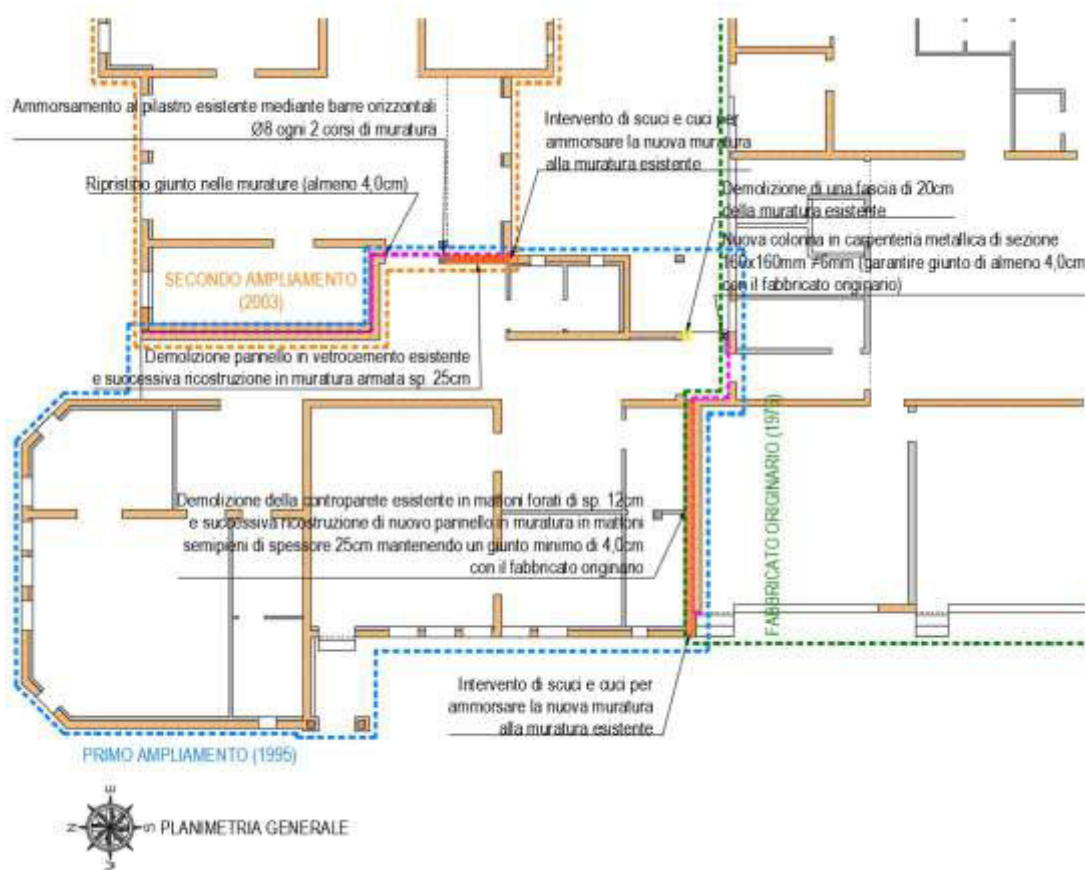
Pianta primo ampliamento con descrizione interventi previsti in progetto
